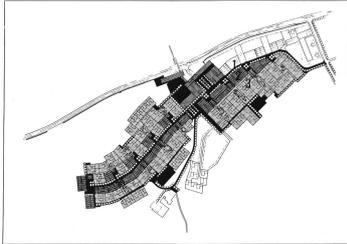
1 öffentliche Aussenräume, deren Form und Ausbildung bestimmt sind; 2 in ihrer Stellung und Grösse vom Plan festgelegte Baukörper; 3 Teile, in welchen der Aussenraum, die Baukörper und deren Stellung im Rahmen gegebener Spielregeln offen bleiben.
